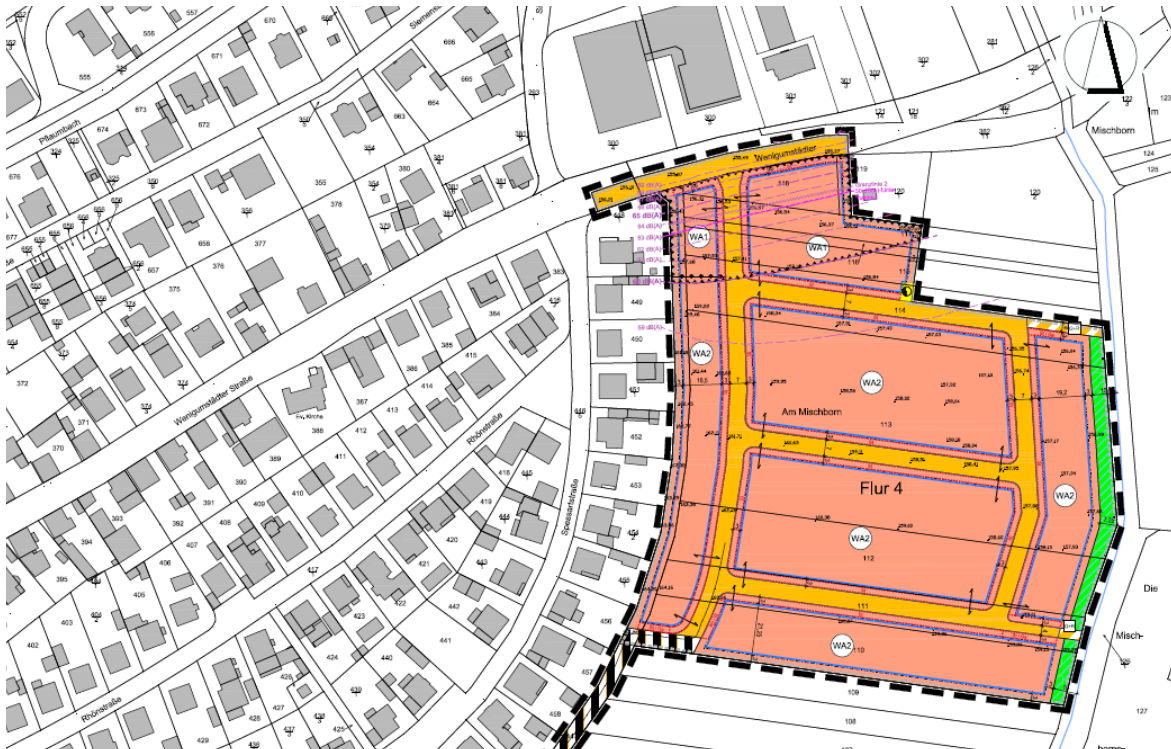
Auszug auf dem Planteil zum Bebauungsplan "Am Mischborn"
